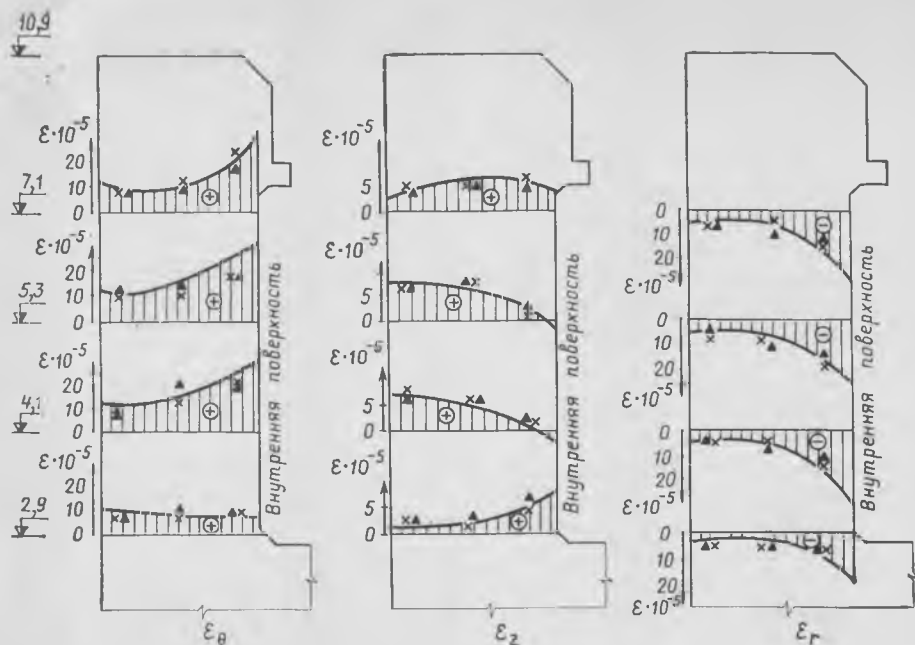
Эпюры деформаций в цилиндрической части корпуса при действии внутреннего давления 7 МПа
